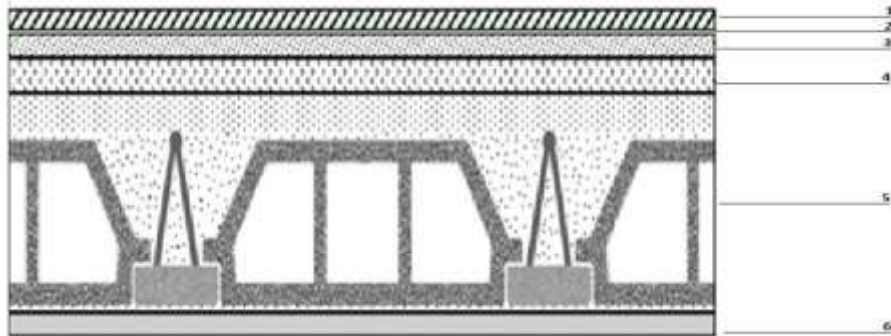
Coupe verticale du plancher courant à corps creux.
